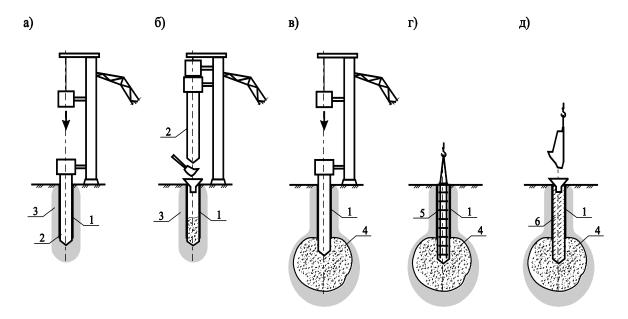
Устройство фундамента в пробитой скважине с пластмассовой оболочкой: а – устройство скважины с использованием пластмассовой трубы; б – отсыпка жесткого материала; в – втромбование жесткого материала; г – установка арматурного каркаса; д – бетонирование скважины; 1 – защитная пластмассовая оболочка; 2 – снаряд (лидер); 3 – уплотненная зона грунта; 4 – уширение из жесткого материала; 5 – арматурный каркас; 6 – бетонная смесь.
